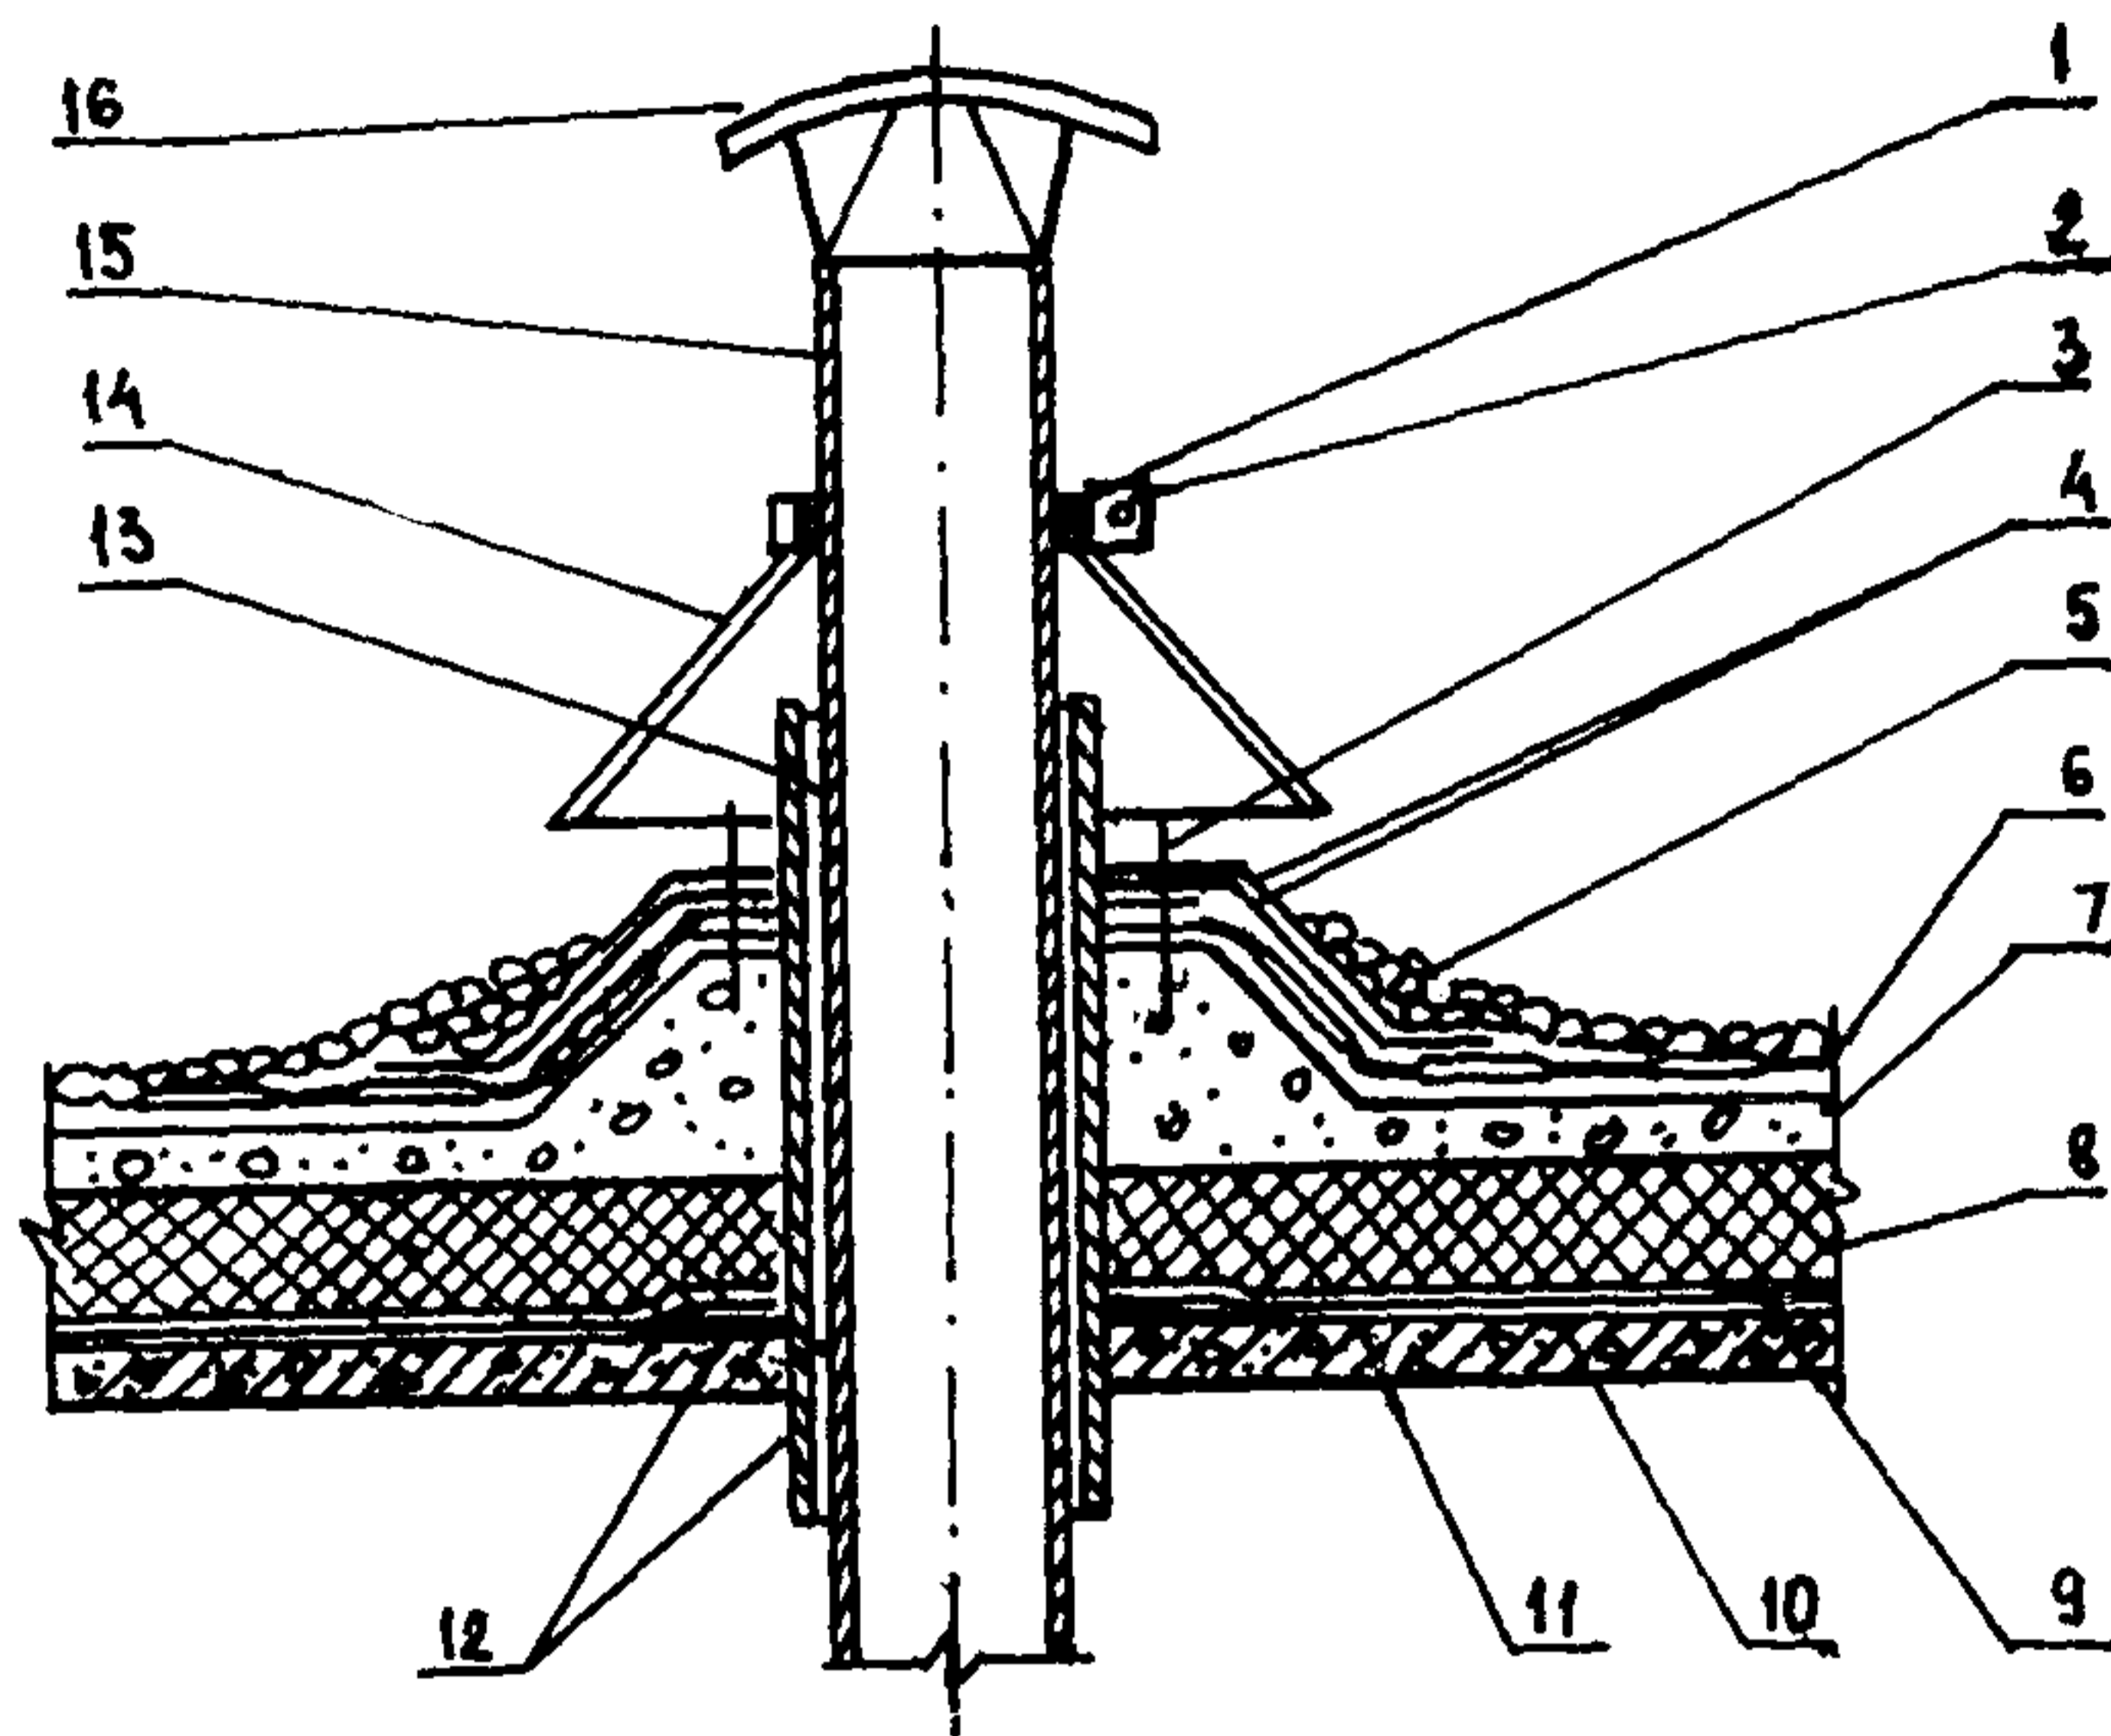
Схема пропуска вытяжной трубы через конструкцию покрытия
